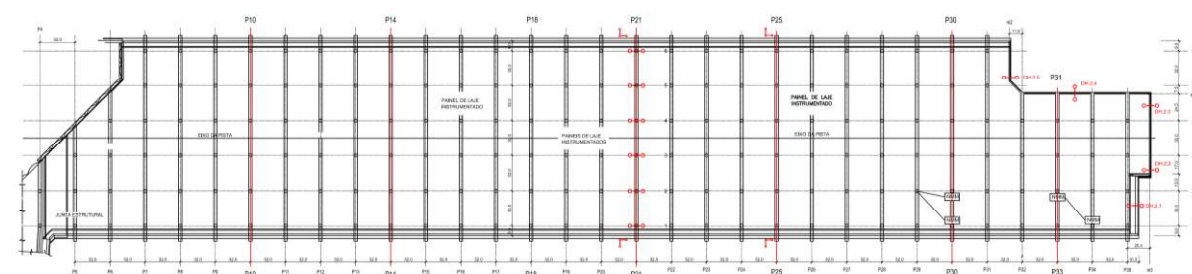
Planta da estrutura de ampliação da pista do Aeroporto da Madeira
